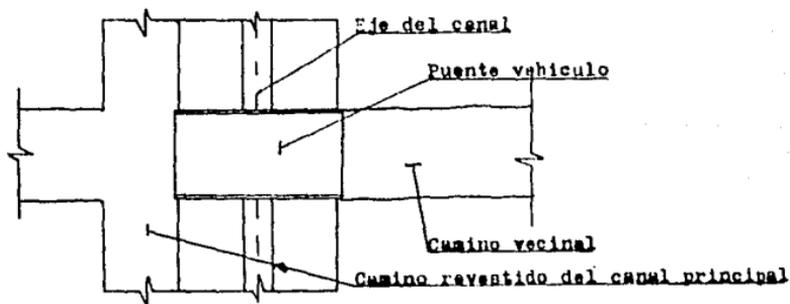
Planta tipo de un puente vehiculo (sin -
